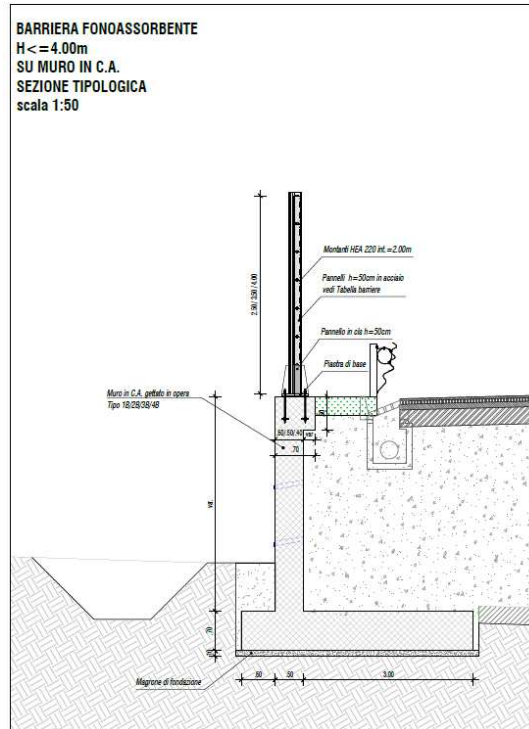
Barriera fonoassorbente testa muro h <= 4.0m
